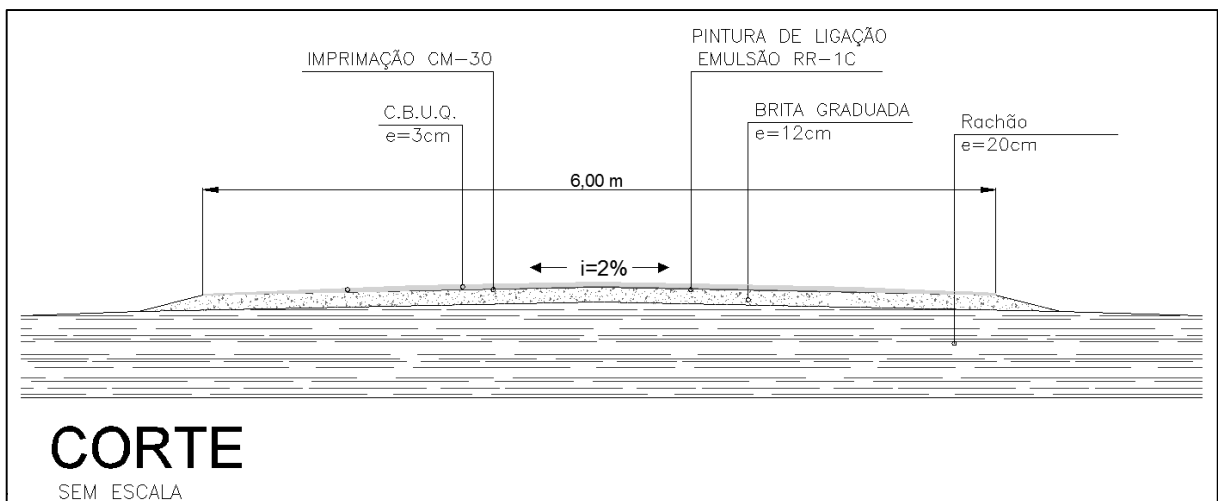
(B) – Seção do Pavimento utilizada entre 2013 e 2016
